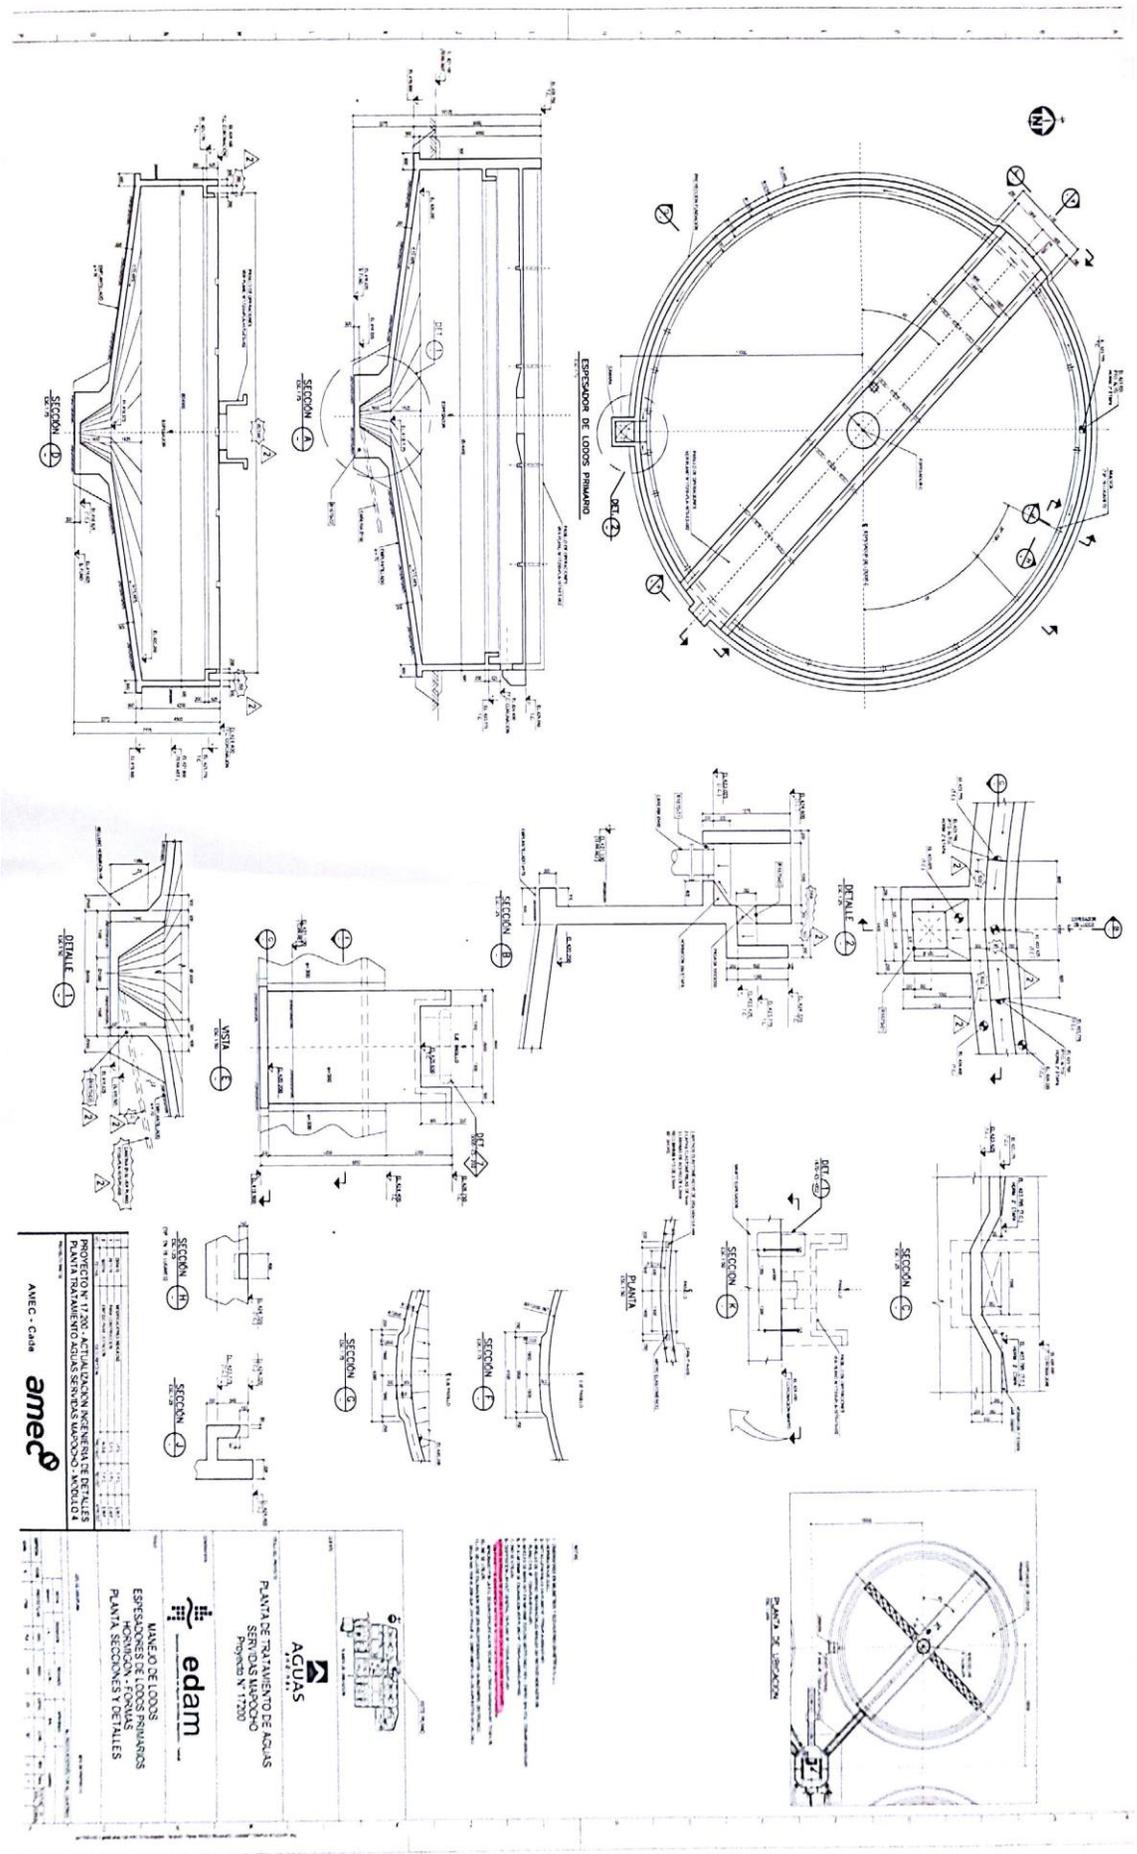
Plano espesador de lodos primarios. (fuente: escáner de plano)
